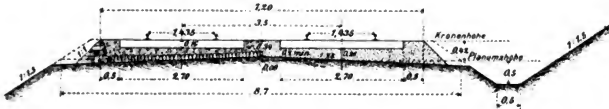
Querschnitt einer eingleisigen Hauptbahn. M. 1:100.
